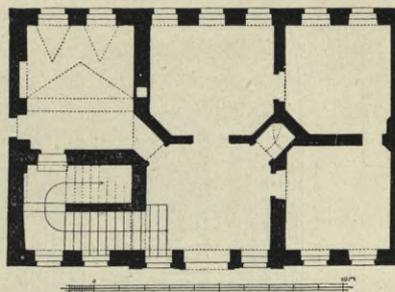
Töpferstraße Nr. 34, Erdgeschoß, Grundriß.
